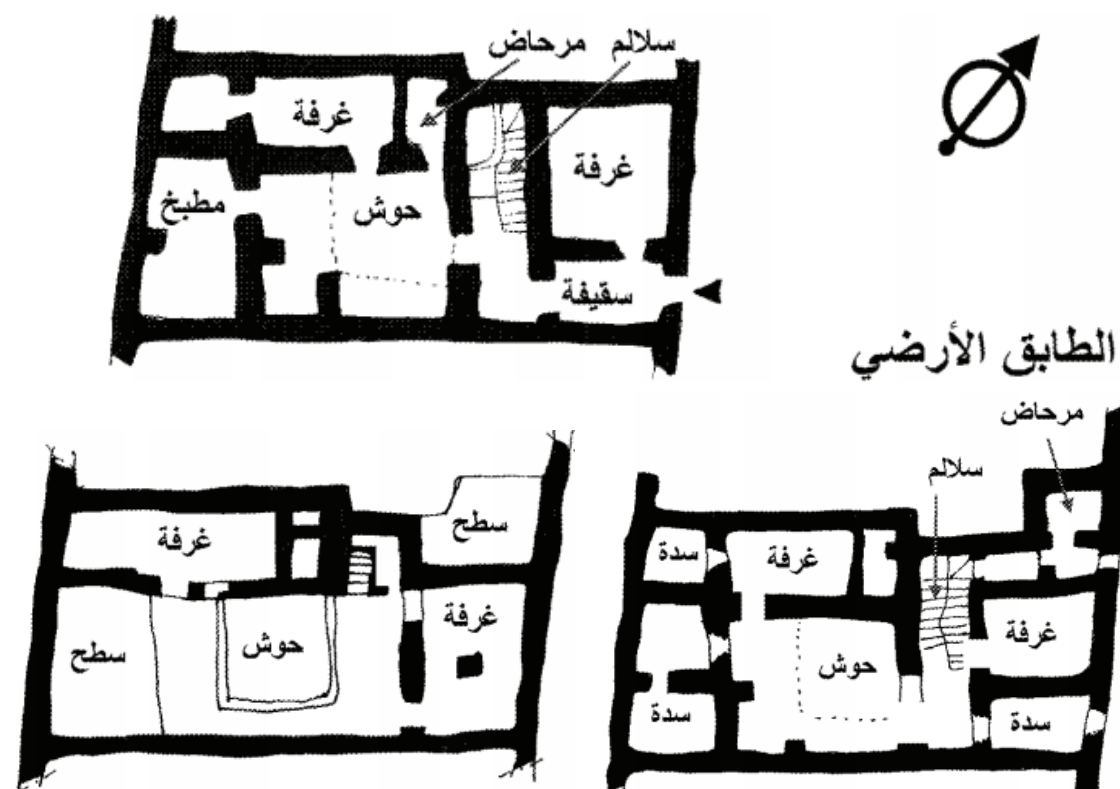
plan d’une maison traditionnelle de Laghouat
